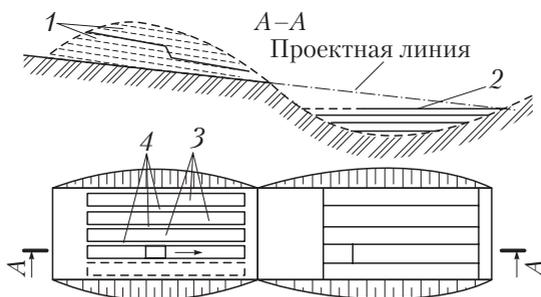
Траншейно-ярусная схема разработки грунта бульдозером:
